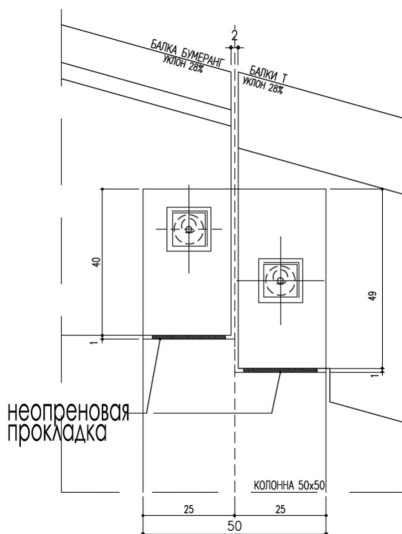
Узел опирания стропильных балок на среднюю колонну
